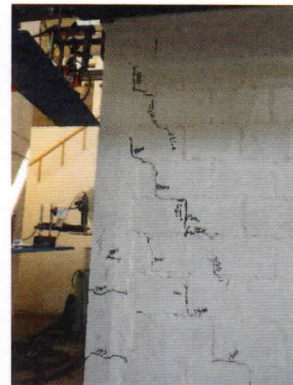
Formación y continuación de grietas diagonales en el mortero en la parte superior Oeste de la cara Sur para una distorsión de 1/1100.
